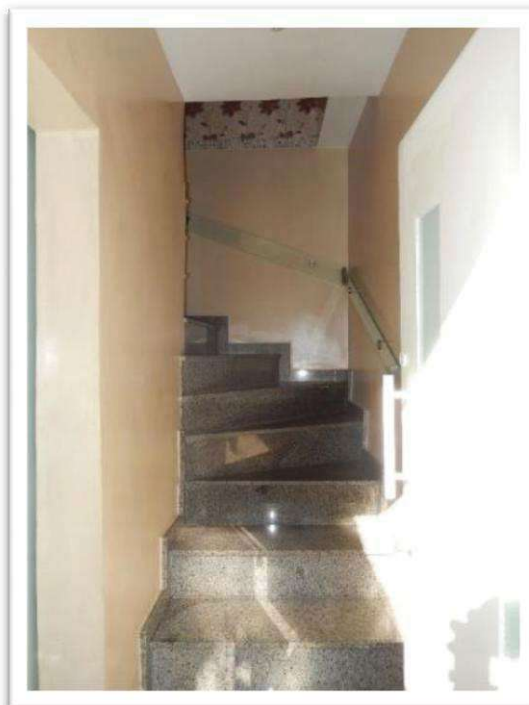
Vista da escada de acesso ao 1º pavimento do Imóvel 1.
